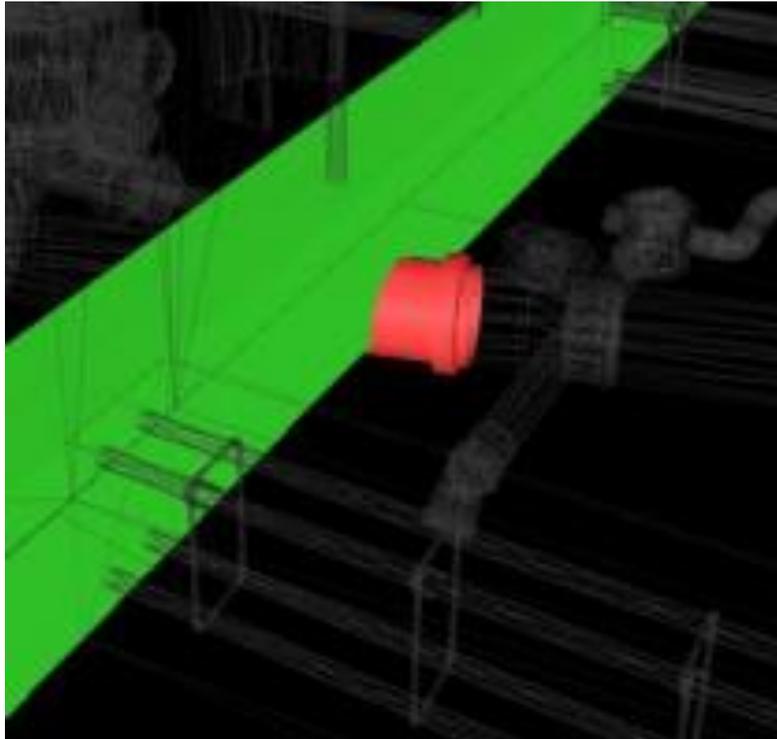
Tubulação dentro da viga. Fonte: Silva, 2017.
